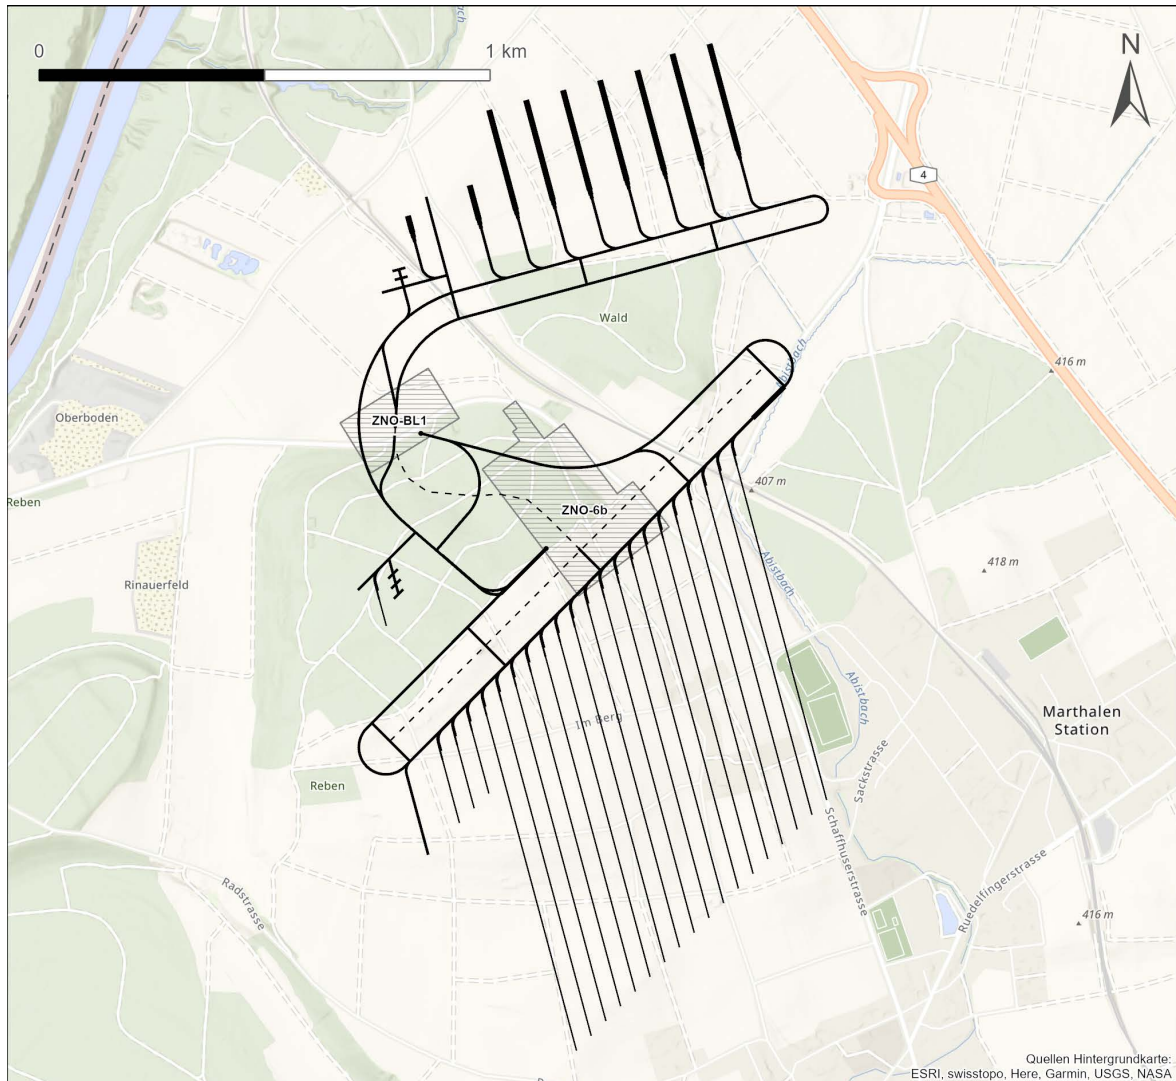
Situationsplan und Grundriss mit der für die KS21 angenommenen modellhaften Anordnung der Anlagen und Bauten für ein Kombilager im Standortgebiet Zürich Nordost (ZNO). Oberflächeninfrastruktur mit der für die KS21 angenommenen modellhaften Anordnung der Oberflächenanlage und Nebenzugangsanlage (beide schraffiert).
